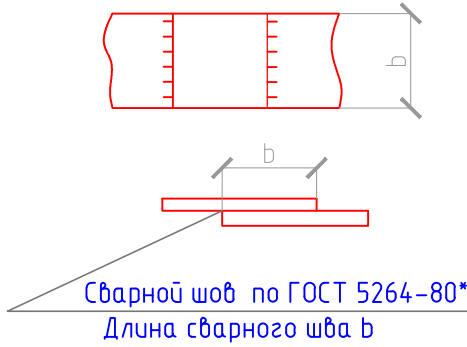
Сварное соединение ответвления полосового заземлителя
